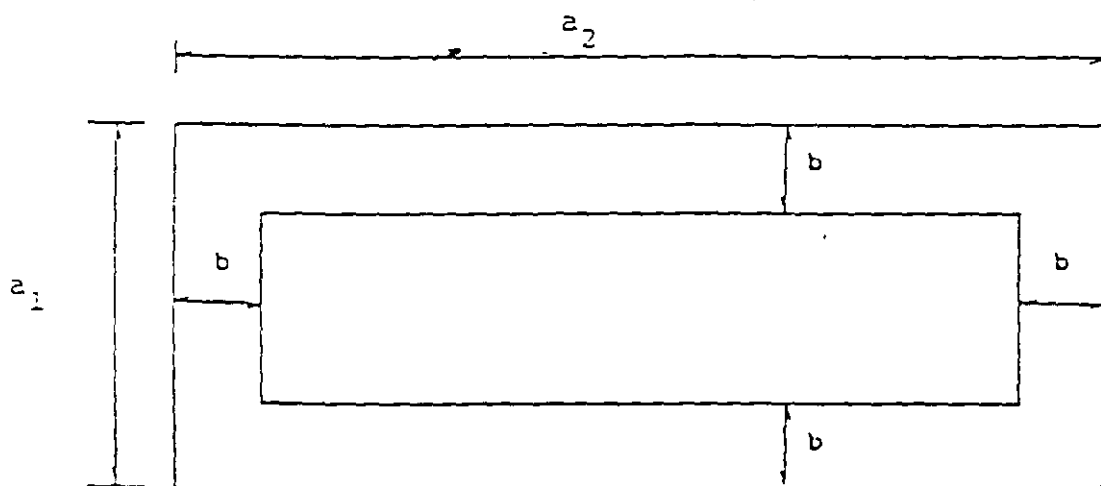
ZAPATAS CORRIDAS CON ANCHO ÚNICO
